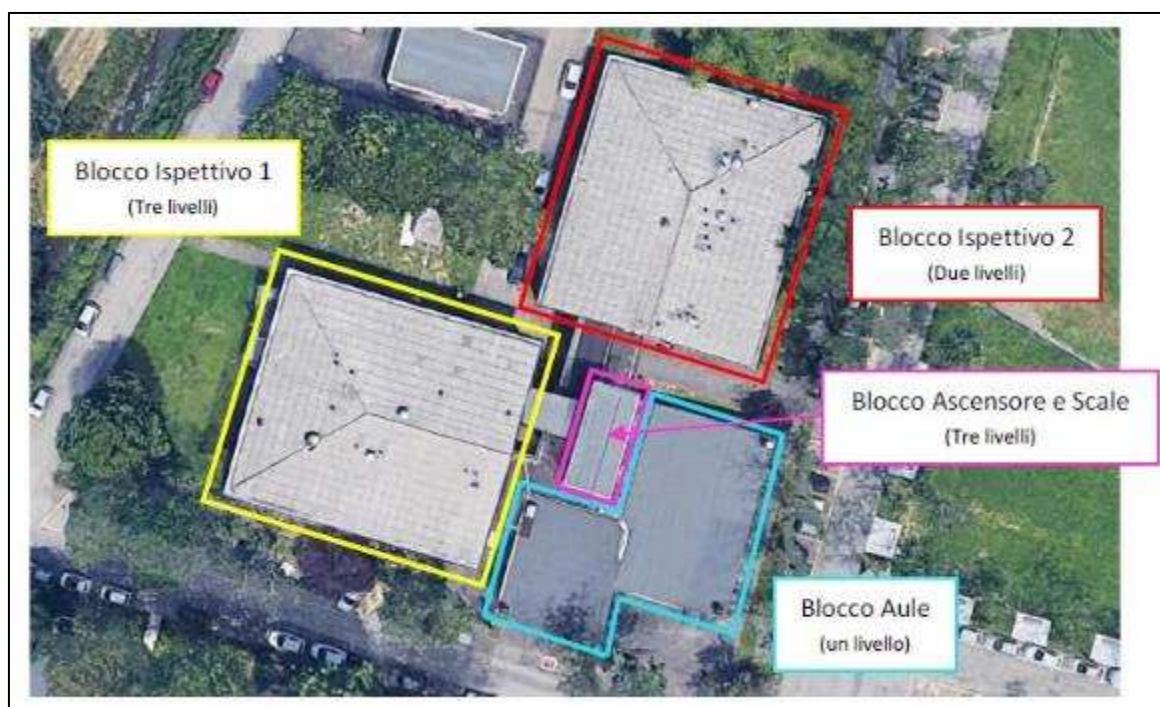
Foto planimetria dell'edificio Padiglione Ispettivi Veterinaria
